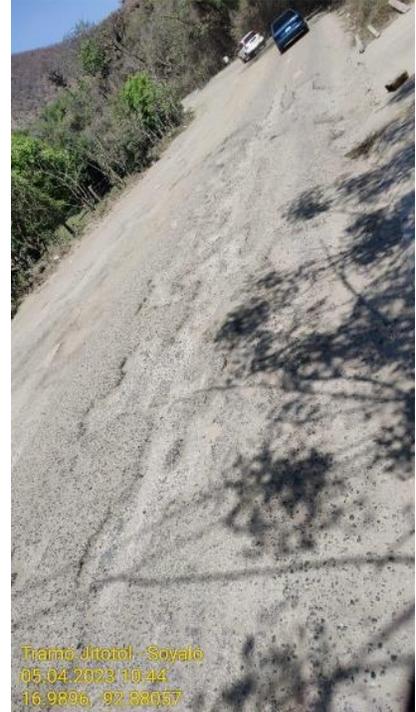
Fallas encontradas en el 206+000 al 206+580.
